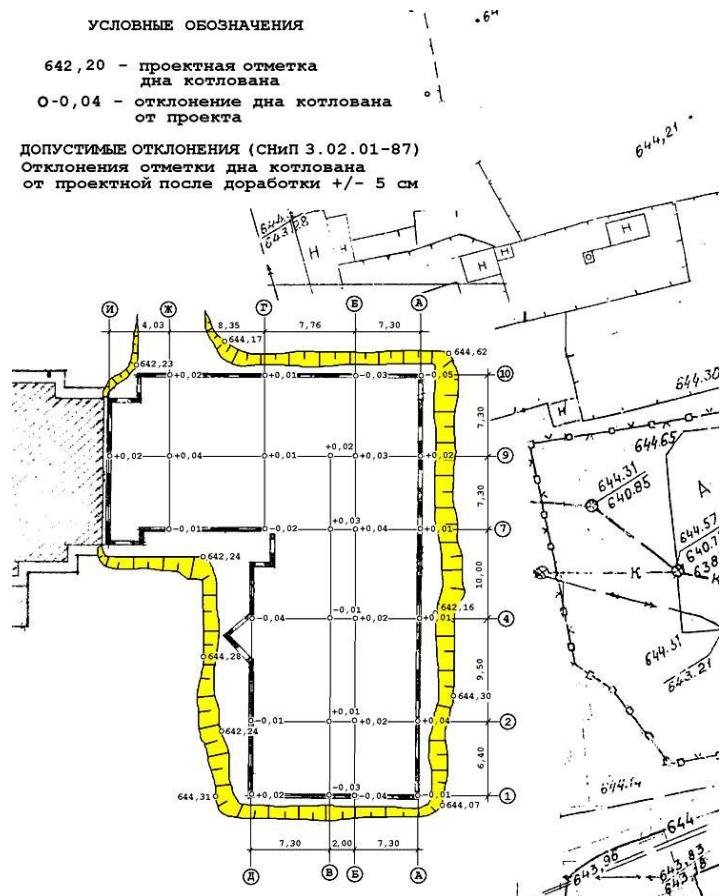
Исполнительная съемка дна котлована под строительство здания
